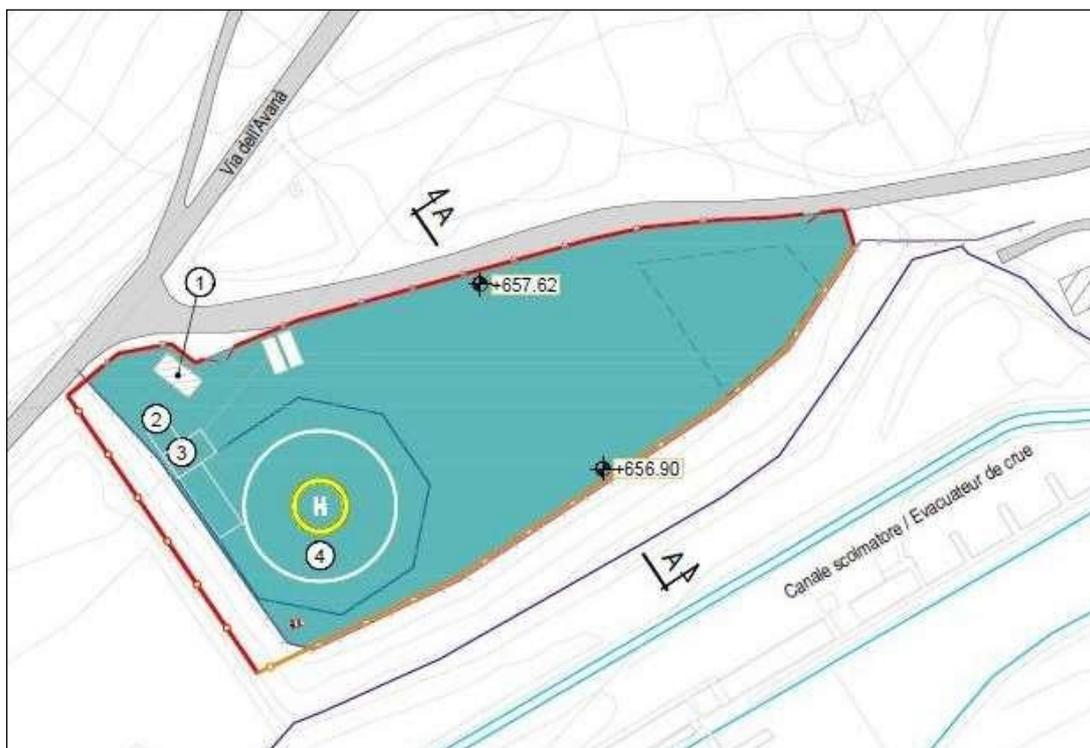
Area di parcheggio Colombera – Planimetria di PE
